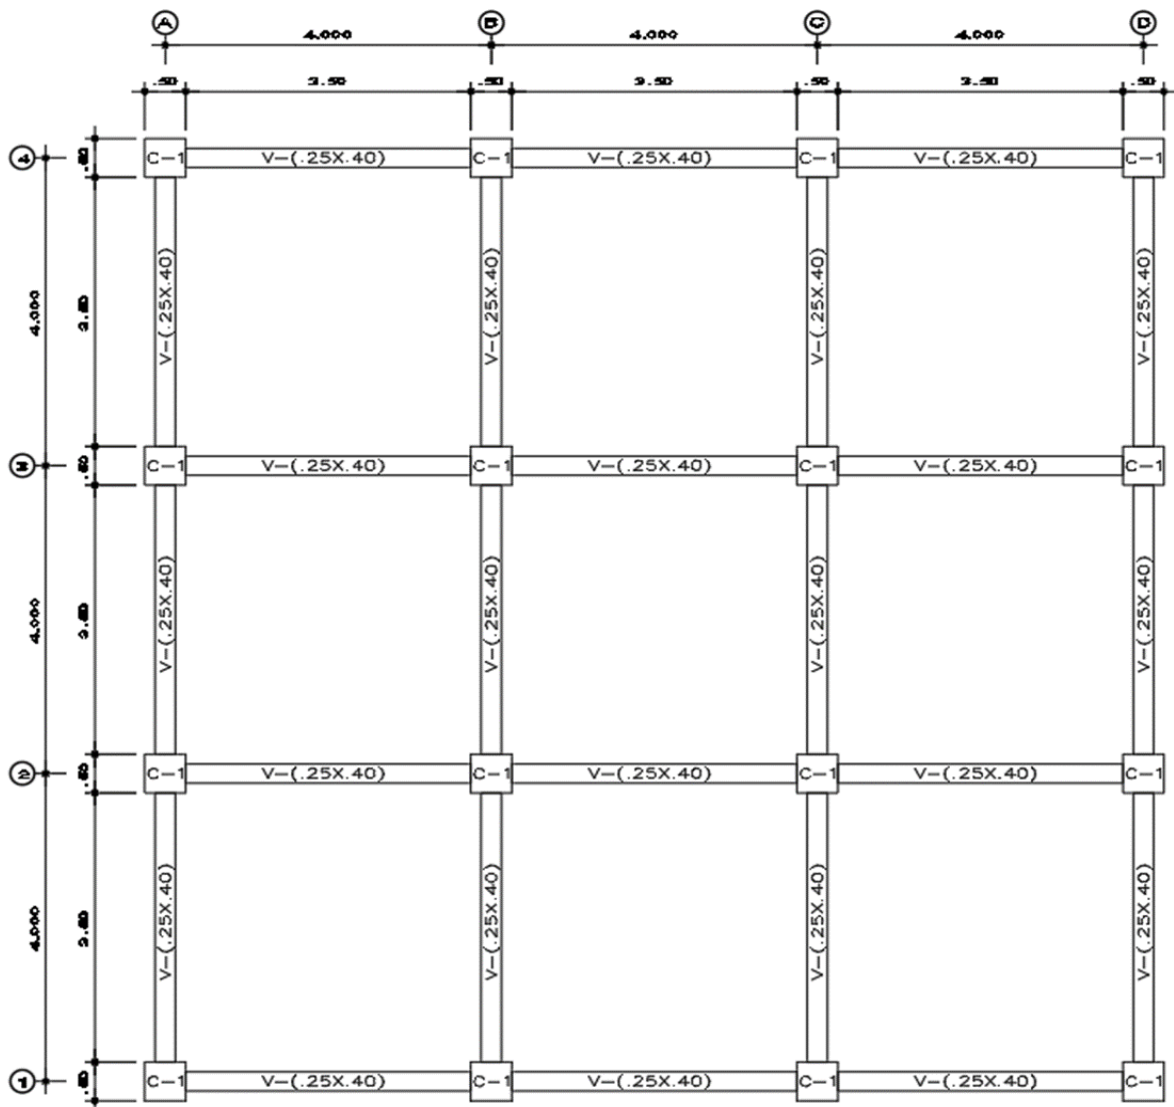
Plano de planta de la edificación la cual su nomenclatura indica:
